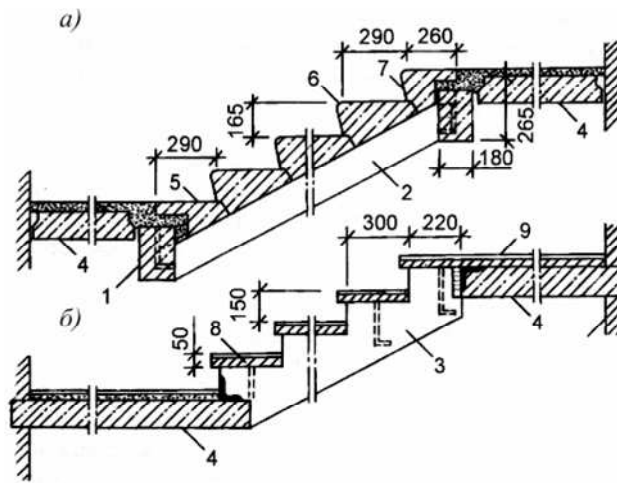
Железобетонные лестницы из мелких элементов:
